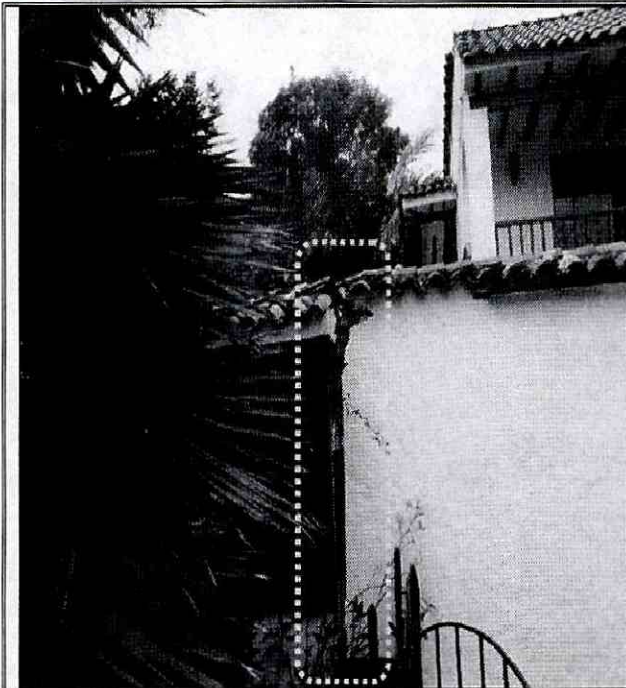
Vista de la fachada de la vivienda ubicada en el predio de la Carrera 47 No. 103 A - 12, en el Barrio Catastral Estoril de la Localidad de Suba. Se observa que presenta dos (2) niveles.
